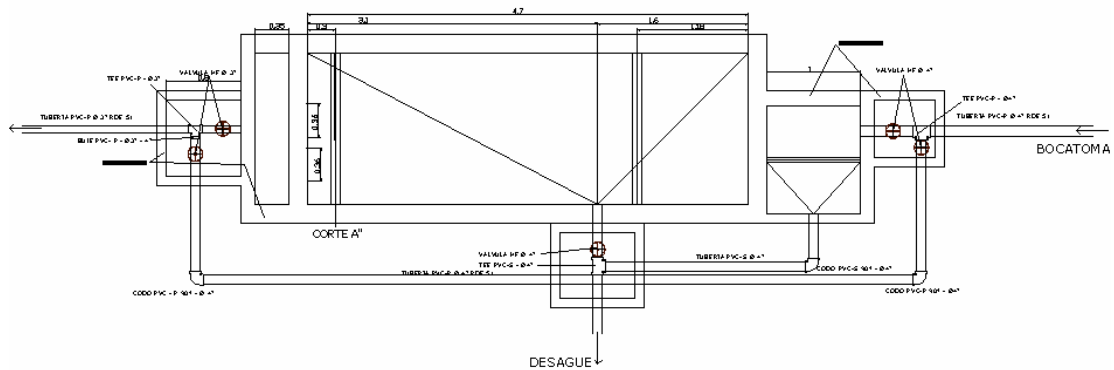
Desarenador – Planta (López Cualla, 1995)
